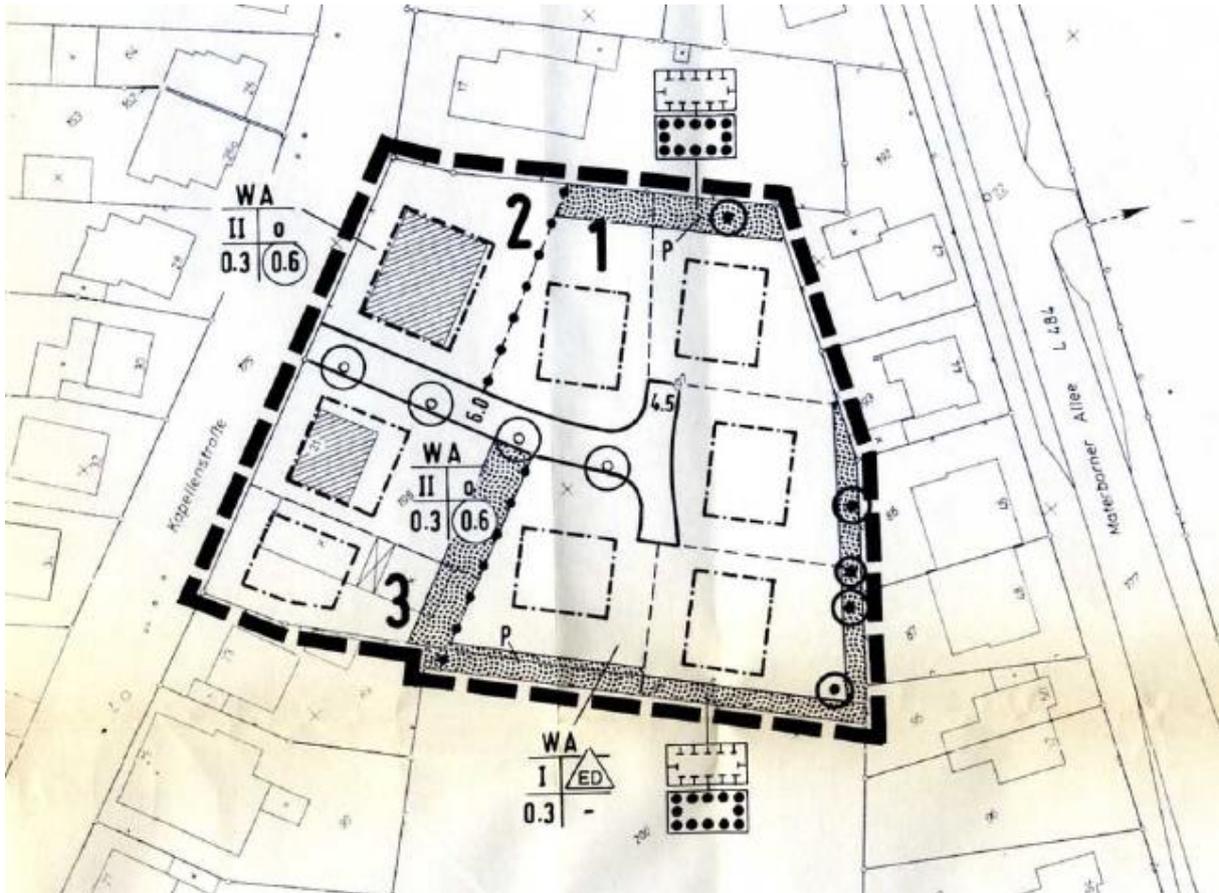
Auszug aus dem Bebauungsplan 4-213-0, unmaßstäblich
